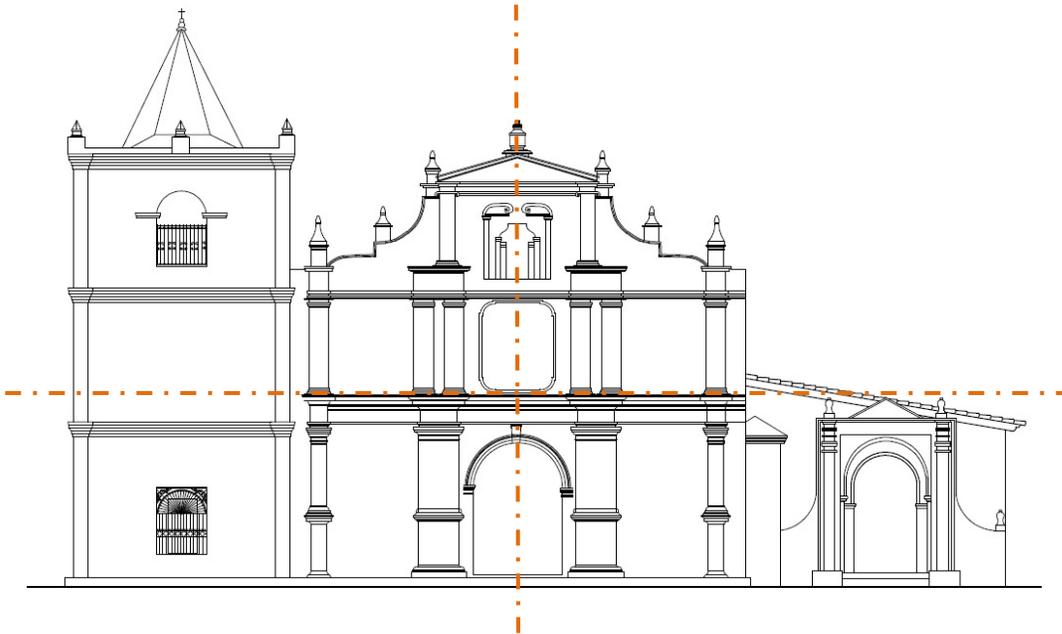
Simetría en fachada principal. Fuente: Grupo de trabajo.
